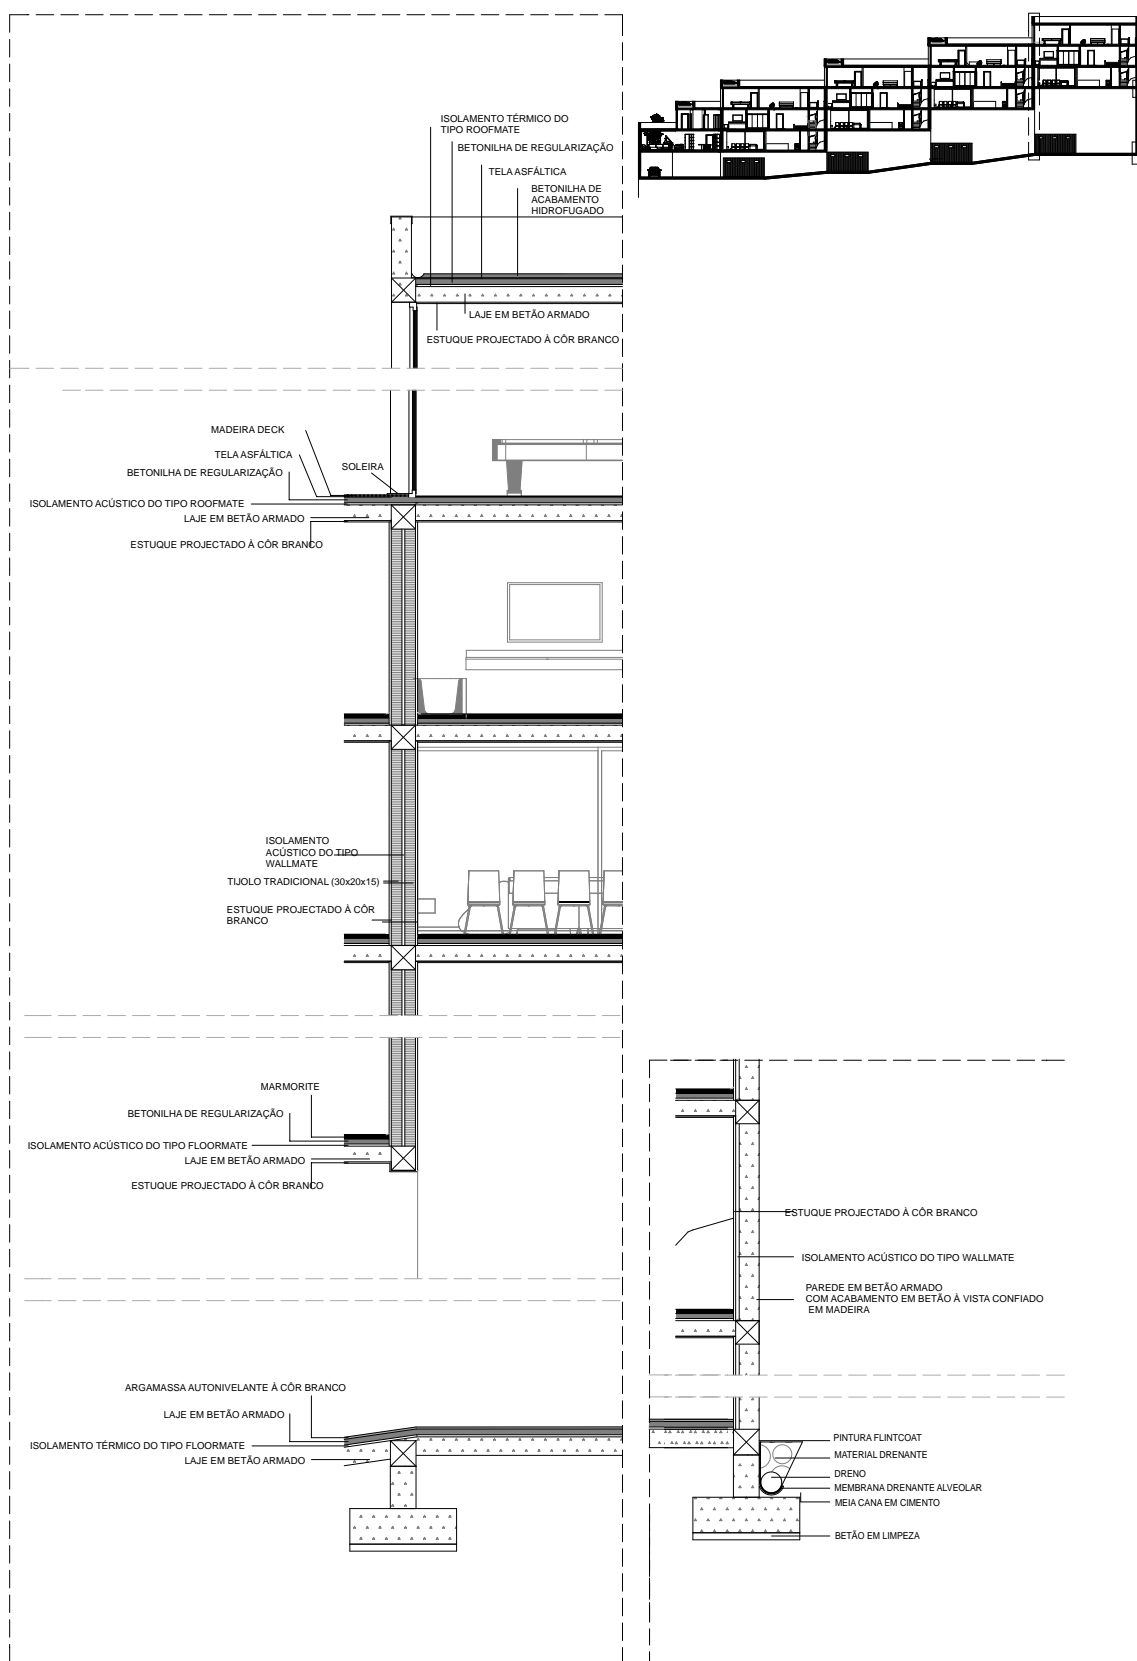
Pormenorização do edifício proposto (escala: 1/50).
